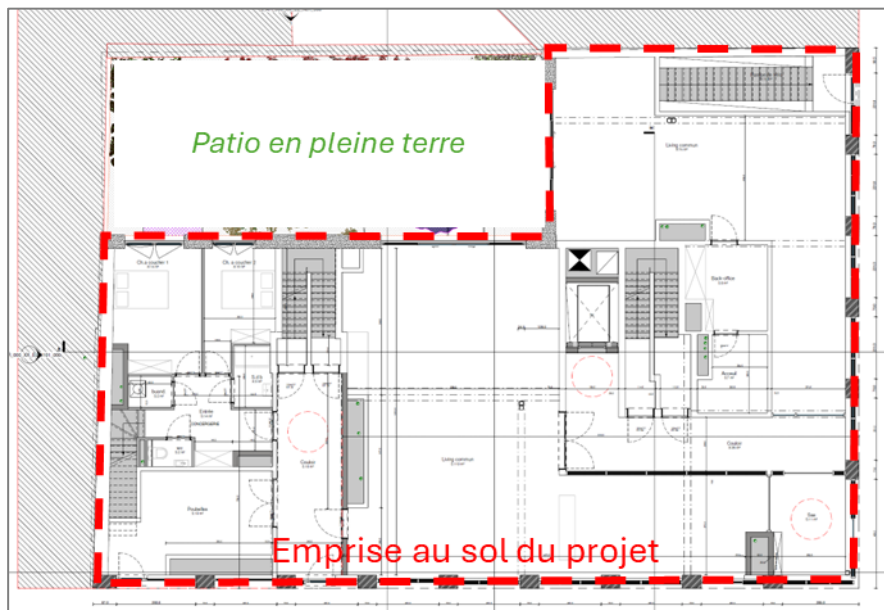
Emprise au sol du projet - Plan du rez-de-chaussée (source : B2Ai)
